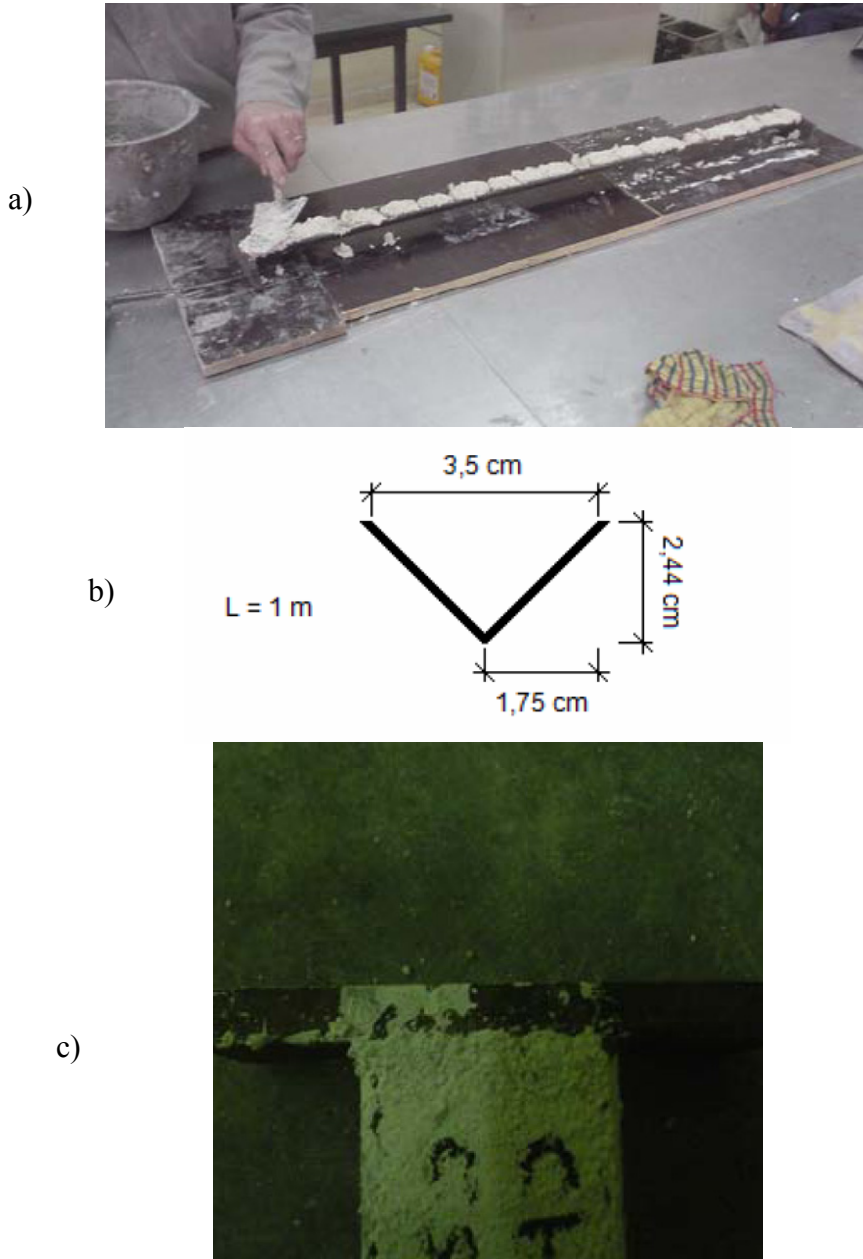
Ensaio de retracção com calha metálica: a) enchimento da calha com argamassa; b) dimensões da calha; c) topo da calha ao fim de 90 dias
